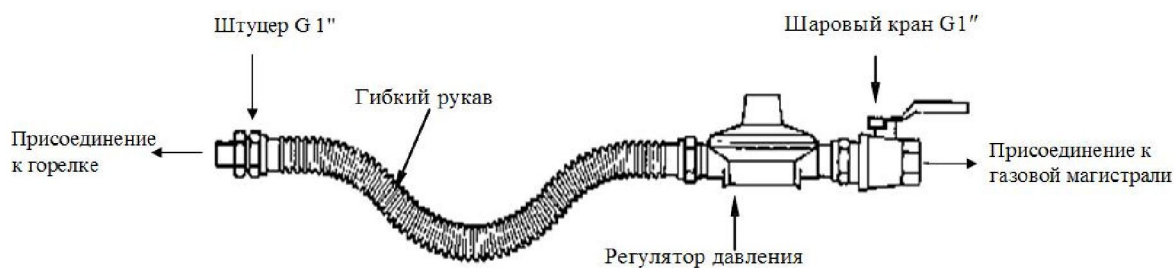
Схема подключения воздушонагревателя к газовой магистрали.
